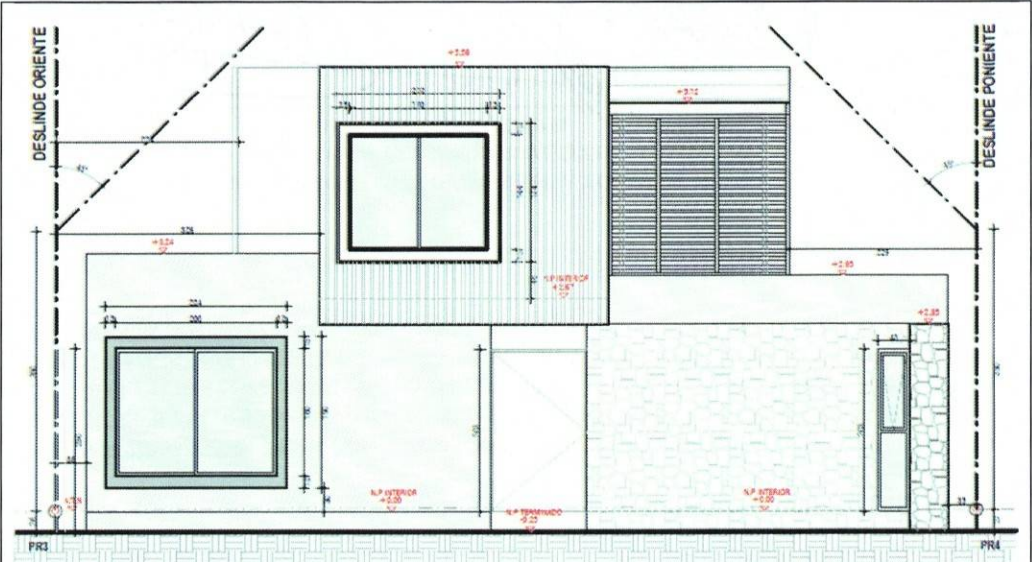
Elevación Norte. Extracto Plano N°A.02/03
